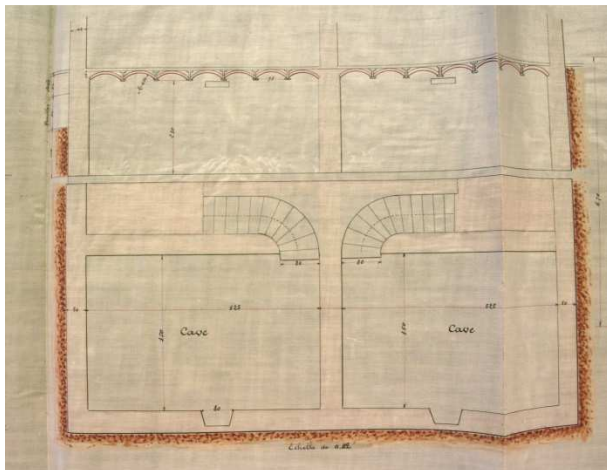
Projet de construction d'un groupe scolaire laïque, privés et préaux. Barbarroux Paul (architecte). Papier entoilé, dessin à l'encre et aquarelle, 300 x 31,5 cm, 11 février 1883. Archives Départementales du Var, 2 Op 64/2.
